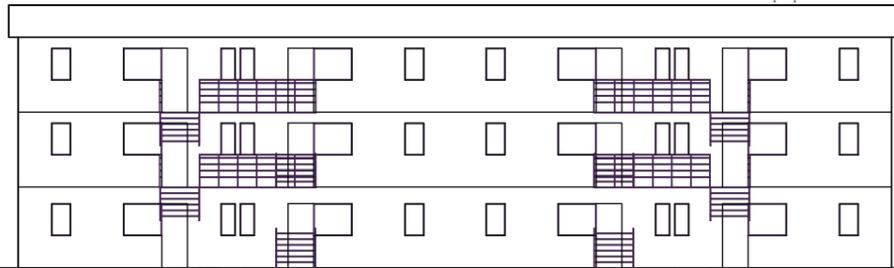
Elevación bloque tipo conjunto Chorrillos.
